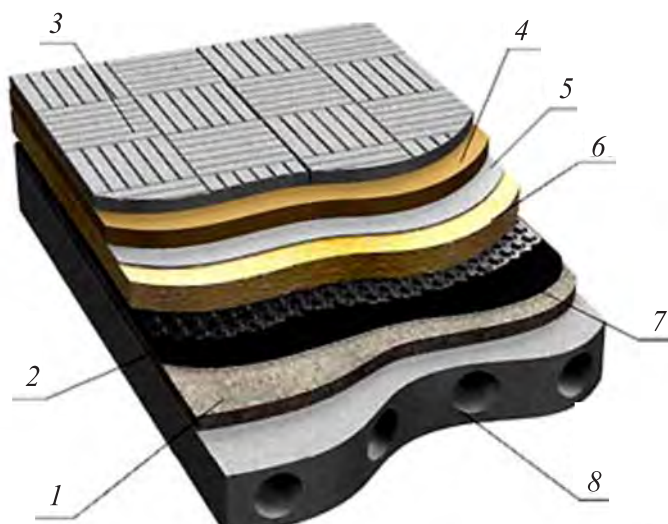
Детализовка эксплуатируемой кровли: 1 — бетонная стяжка; 2 — дренажный материал; 3 — тротуарная плитка; 4 — песчано-цементная подушка; 5 — геотекстиль; 6 — утеплитель; 7 — гидроизоляционная мембрана; 8 — бетонное основание (плита перекрытия)
